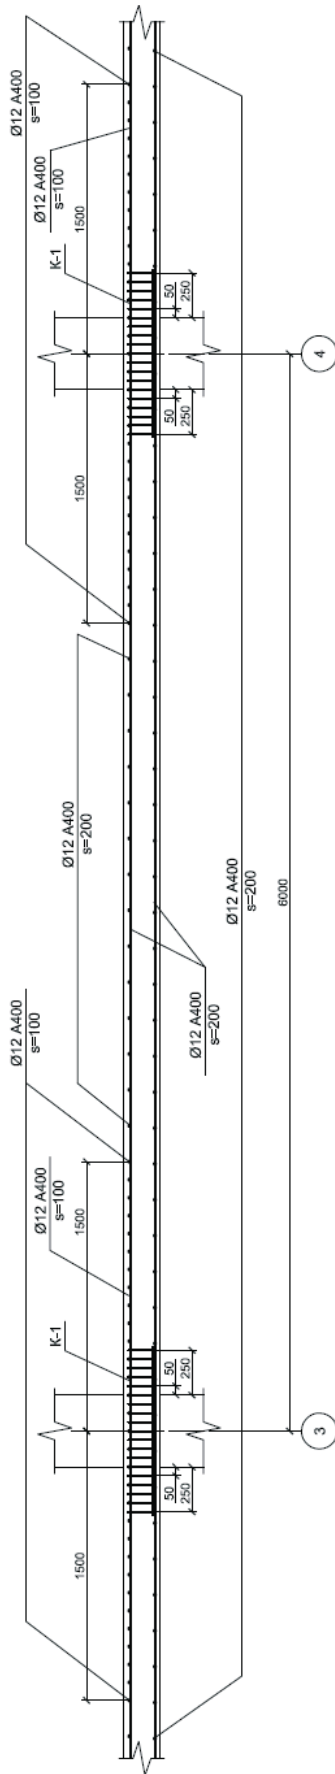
Фрагмент дополнительного армирования плиты перекрытия в зоне продавливания
